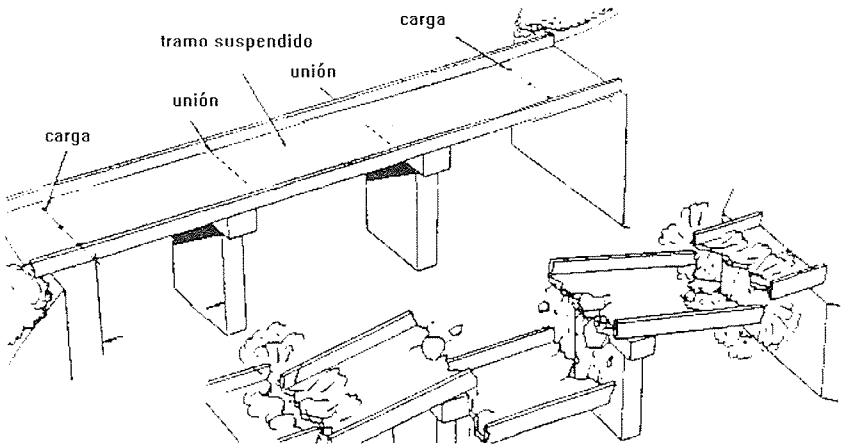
Destrucción completa de un puente cantilever con tramo suspendido
